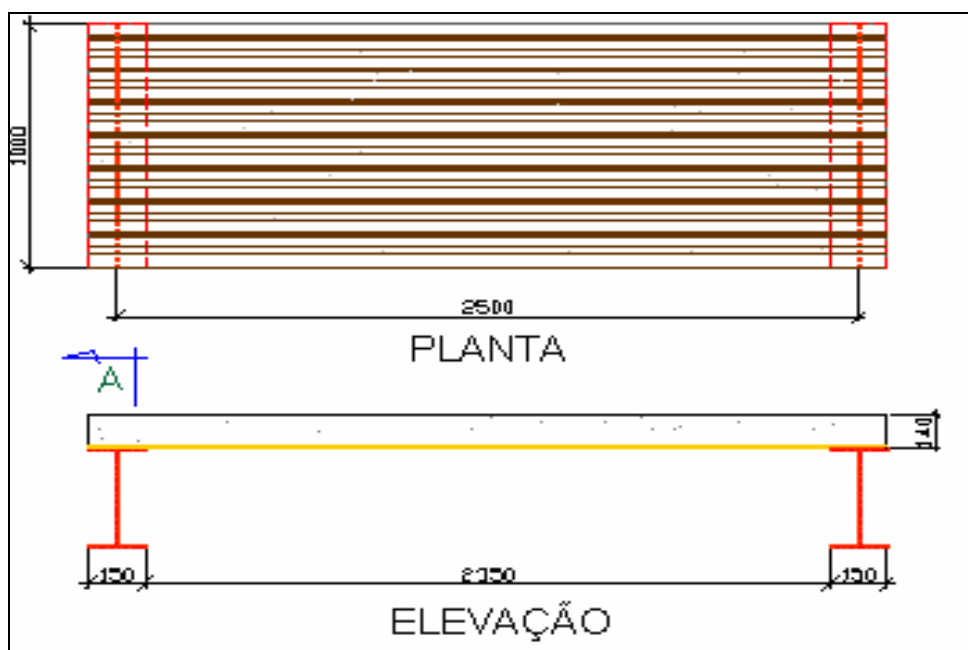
Exemplo para a laje mista utilizando-se o DECK 60-USIMINAS
